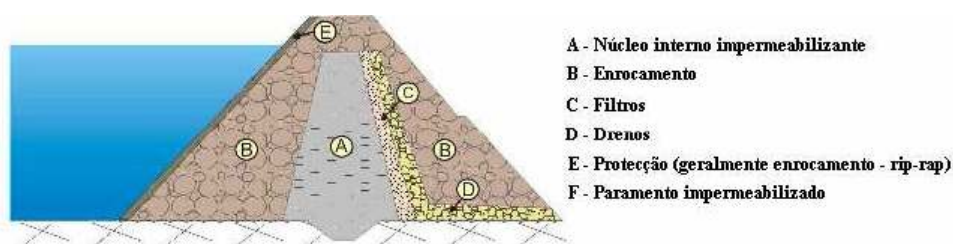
Barragens de aterro de enrocamento – núcleo impermeável [6]
